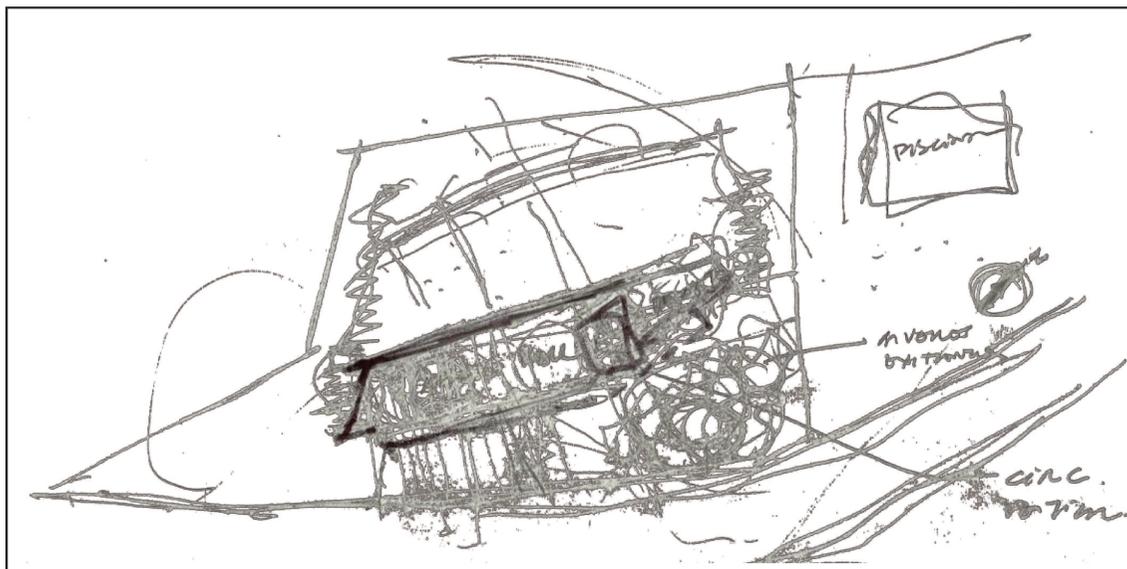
Croqui especulativo em planta realizado pelo Arquiteto Experiente 3.
